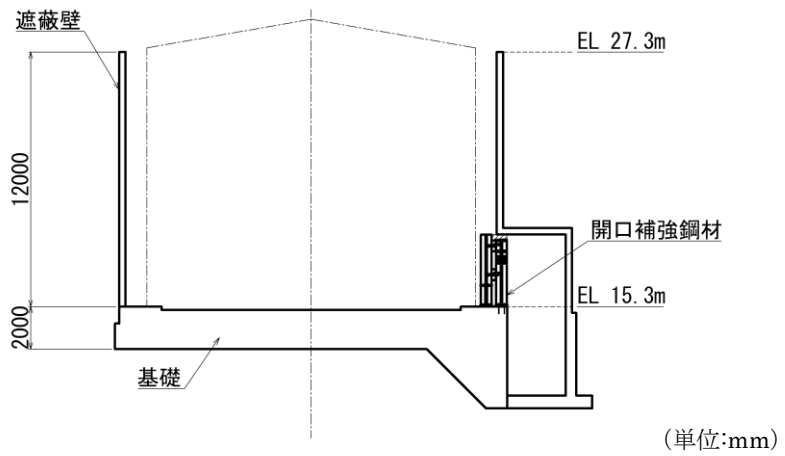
補助復水貯蔵タンク遮蔽壁 断面図 (A-A 断面, 東西)
